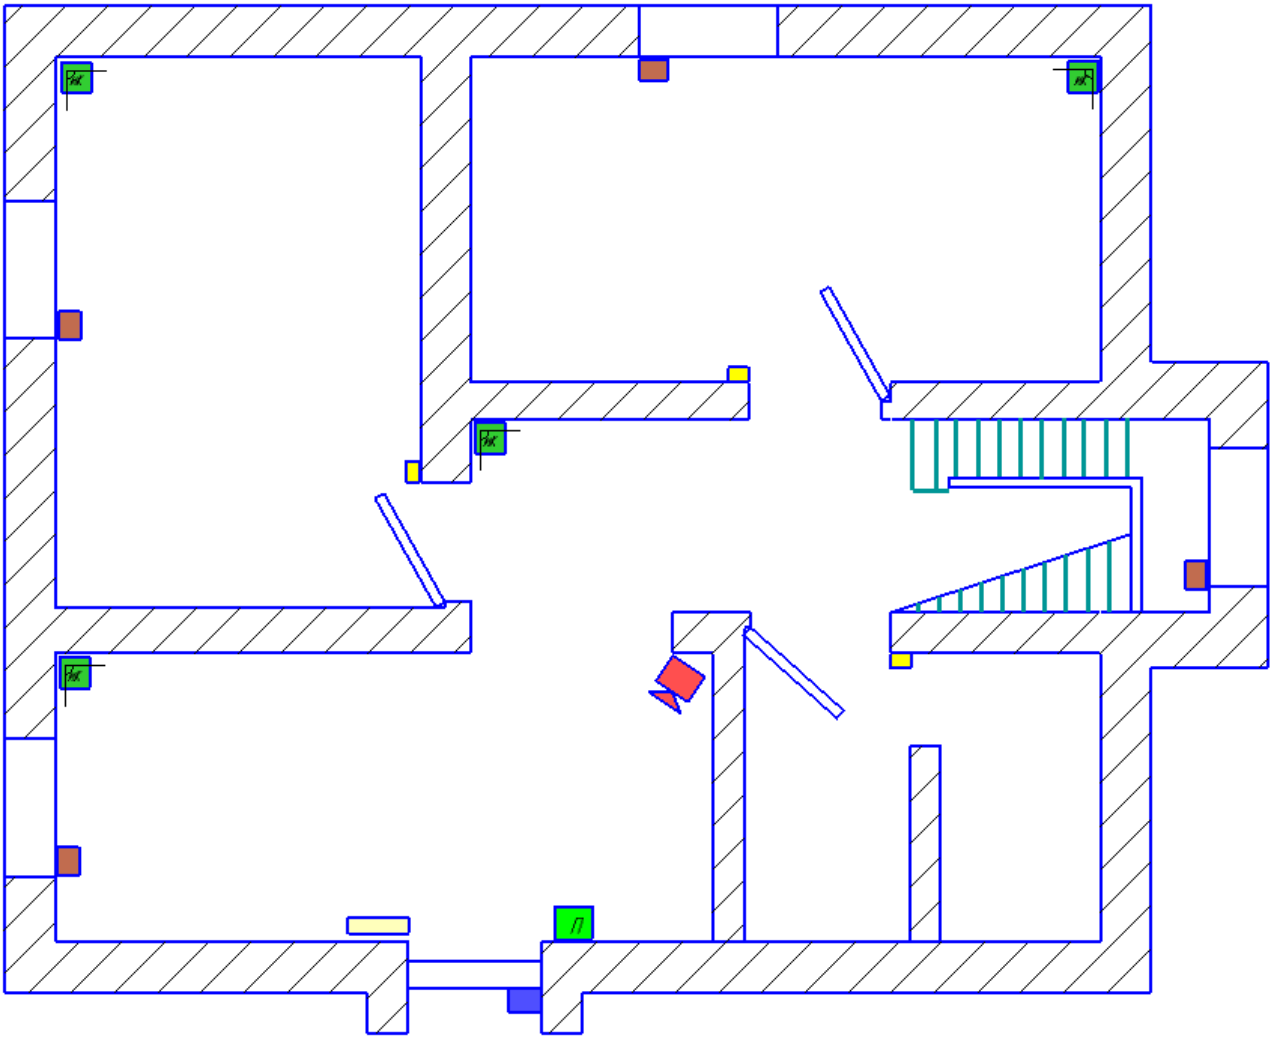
План охранной системы 1го этажа “Умный дом”
